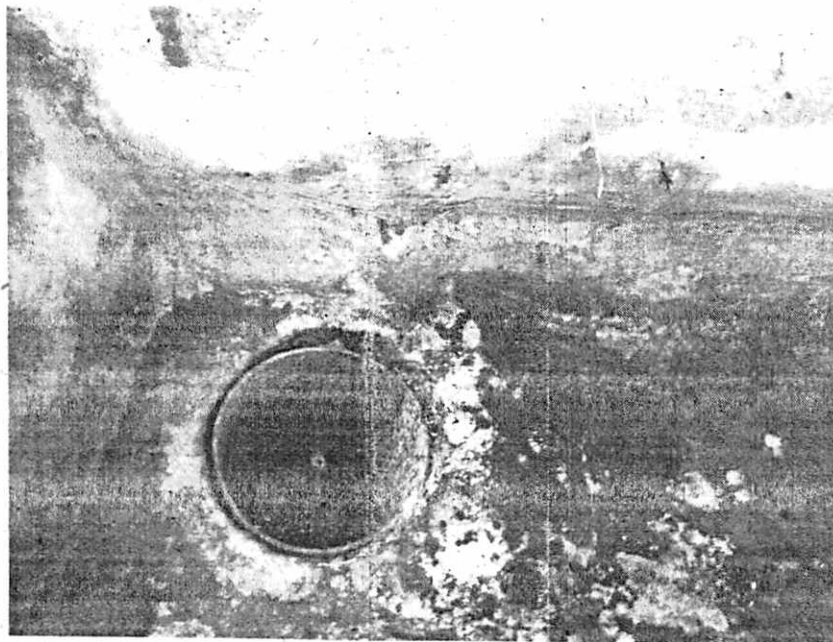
Detalhe do ralo da viga calha, tubo de descida das águas pluviais.
